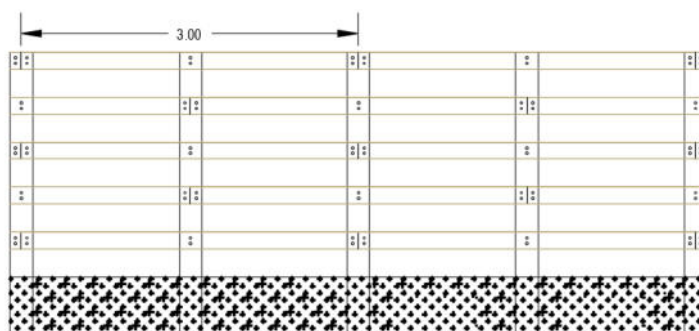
Detalle de la disposición al tresbolillo de las traviesas.
